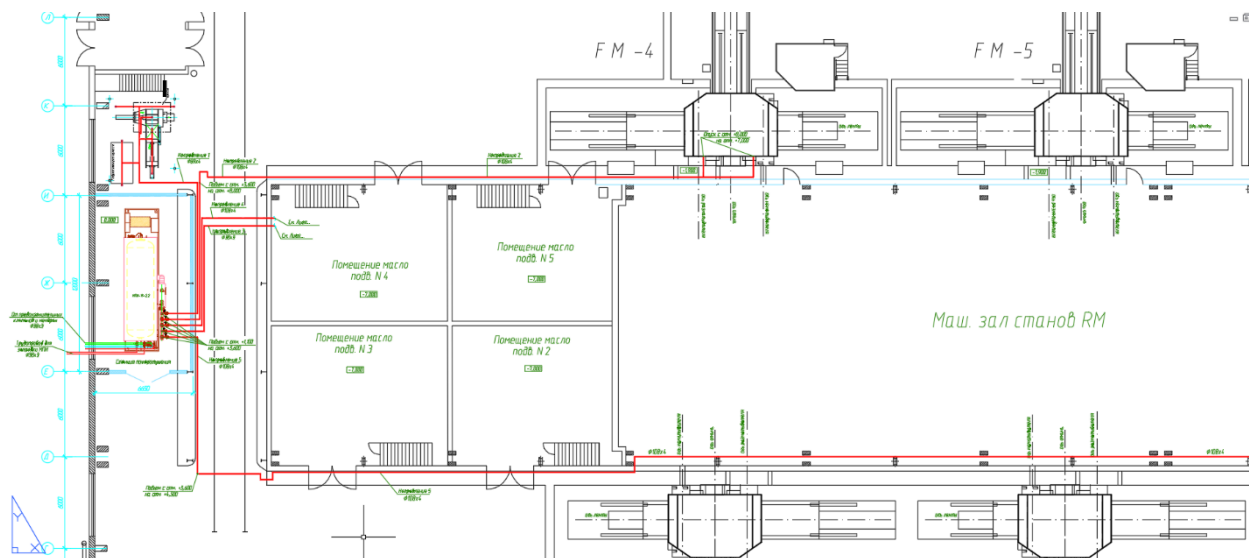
План расположения трубопроводов установки пожаротушения.
